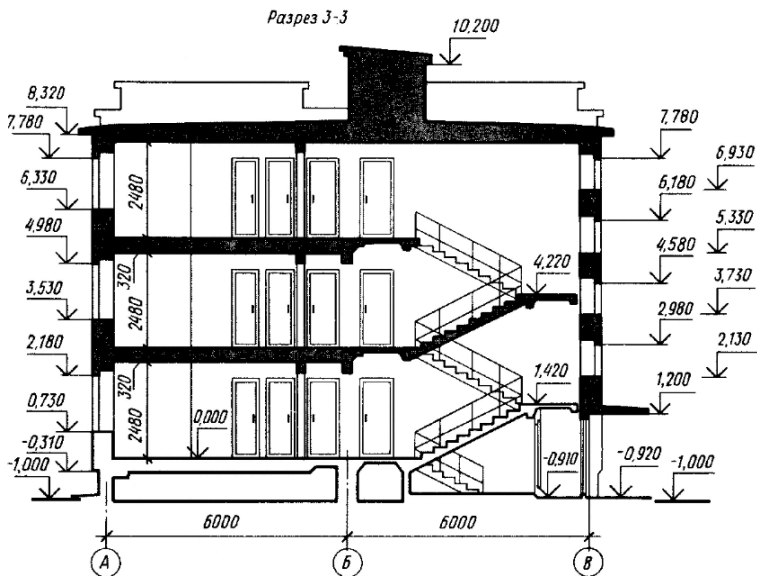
Архитектурный разрез жилого дома по лестничной клетке
